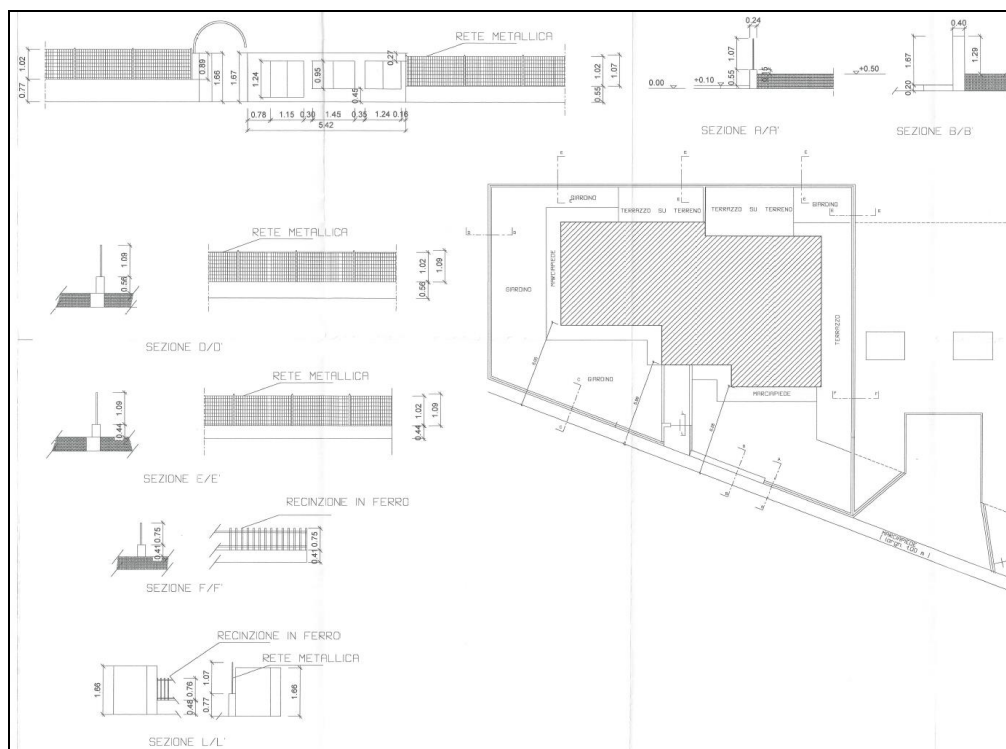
Recinzione Concessione Edilizia Pratica n. I01/0081 del 24/06/2002 – ([Allegato N.7](#))
